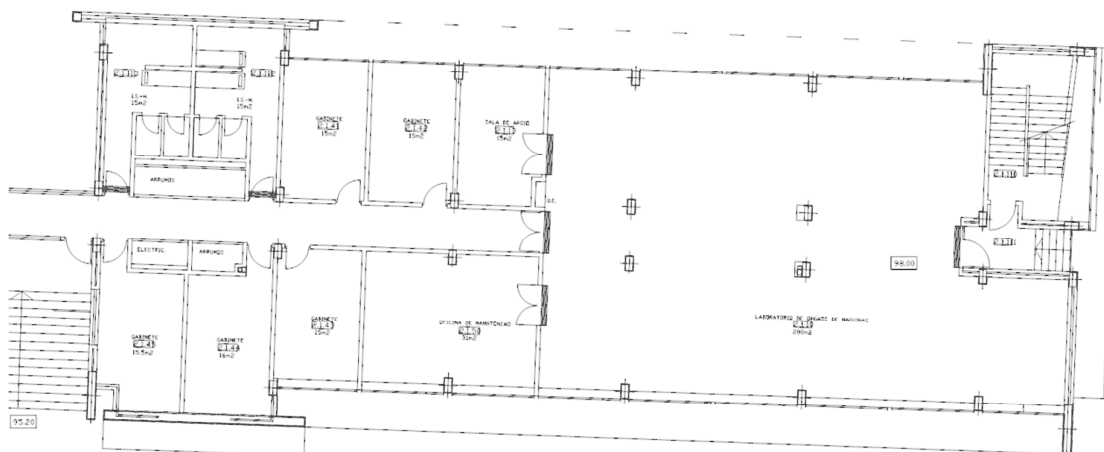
Vista superior detalhada do corpo Norte, piso nº2.
